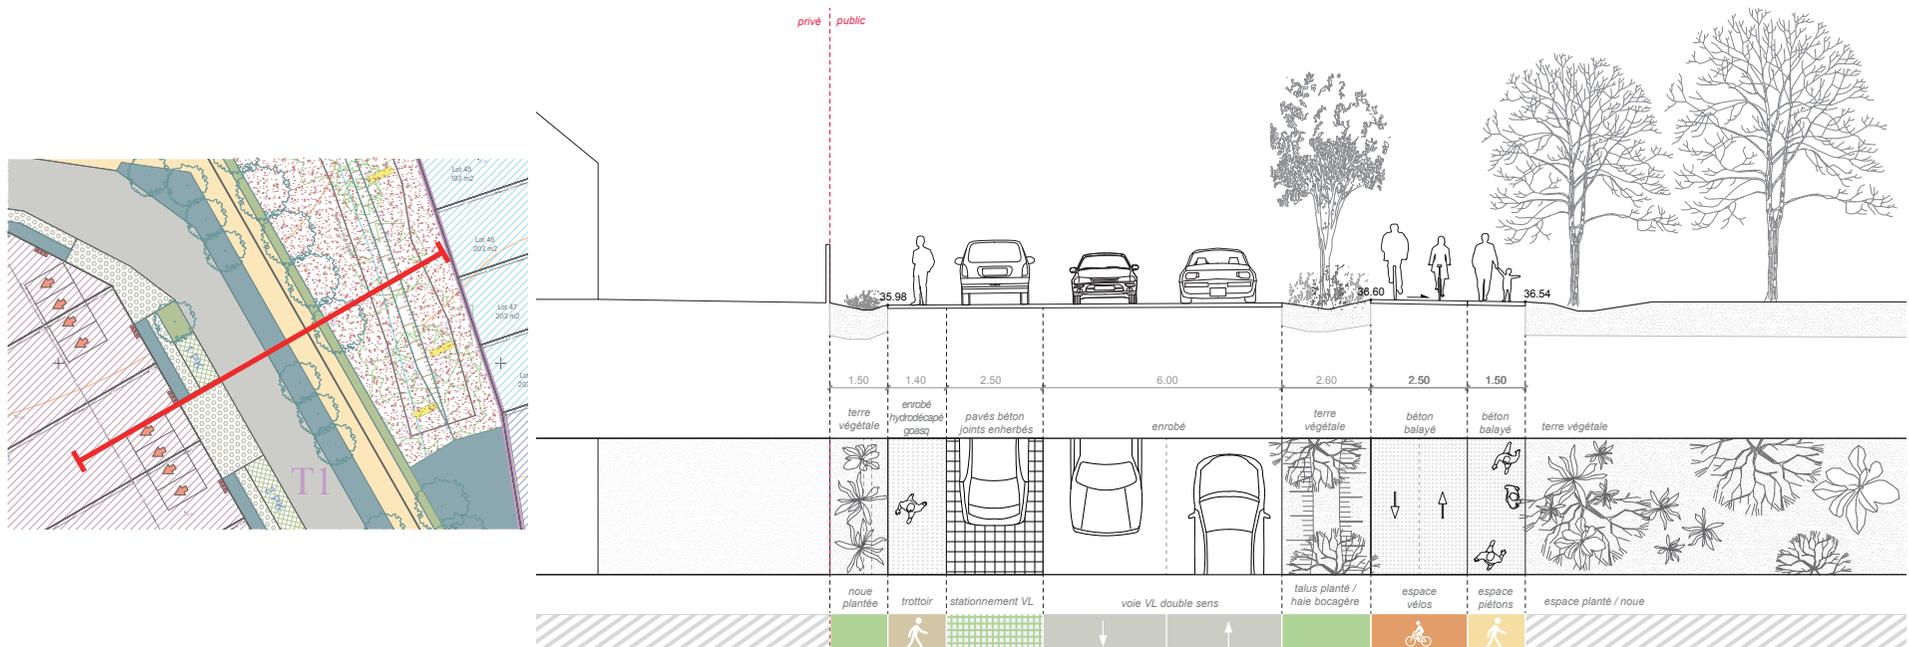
Coupe d'un sentier piéton au niveau d'une noue
